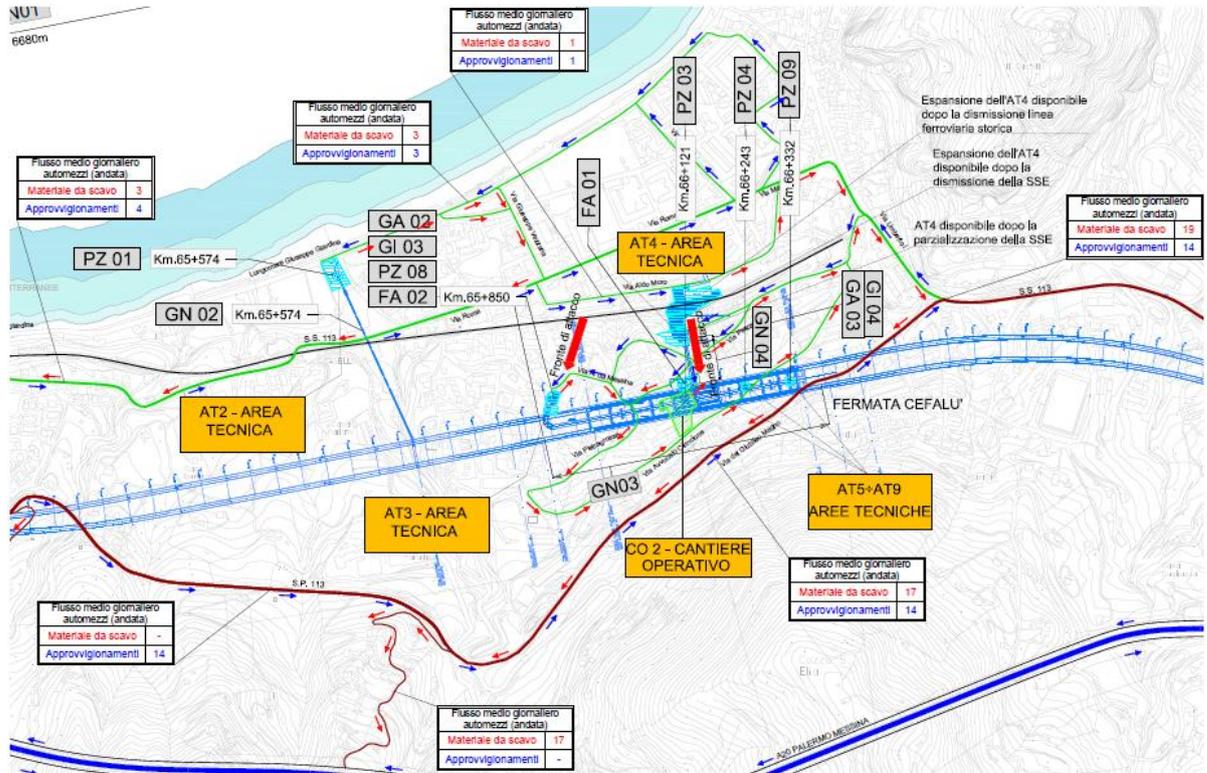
Stralcio planimetria dei flussi area Stralcio Cefalù
